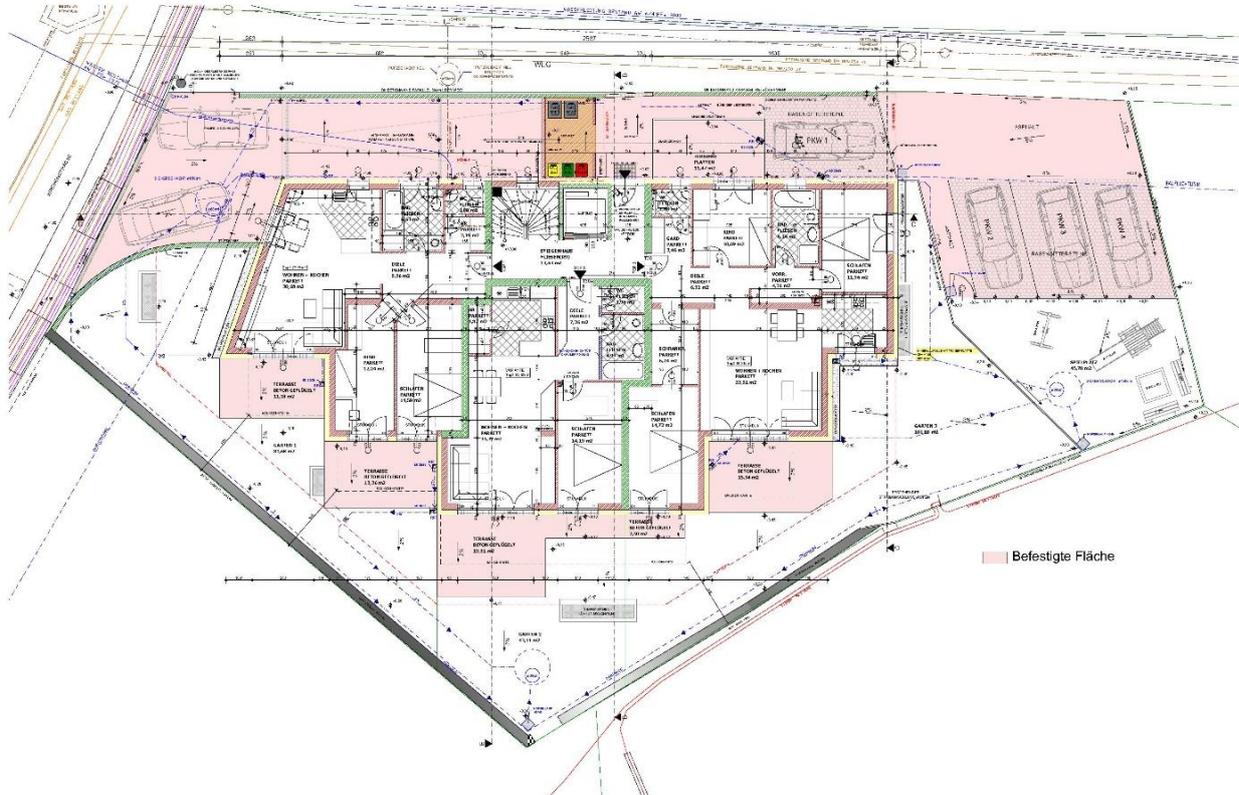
Erschließung Wohnhausanlage Salzburg (Archiv Firma Heissenberger)
